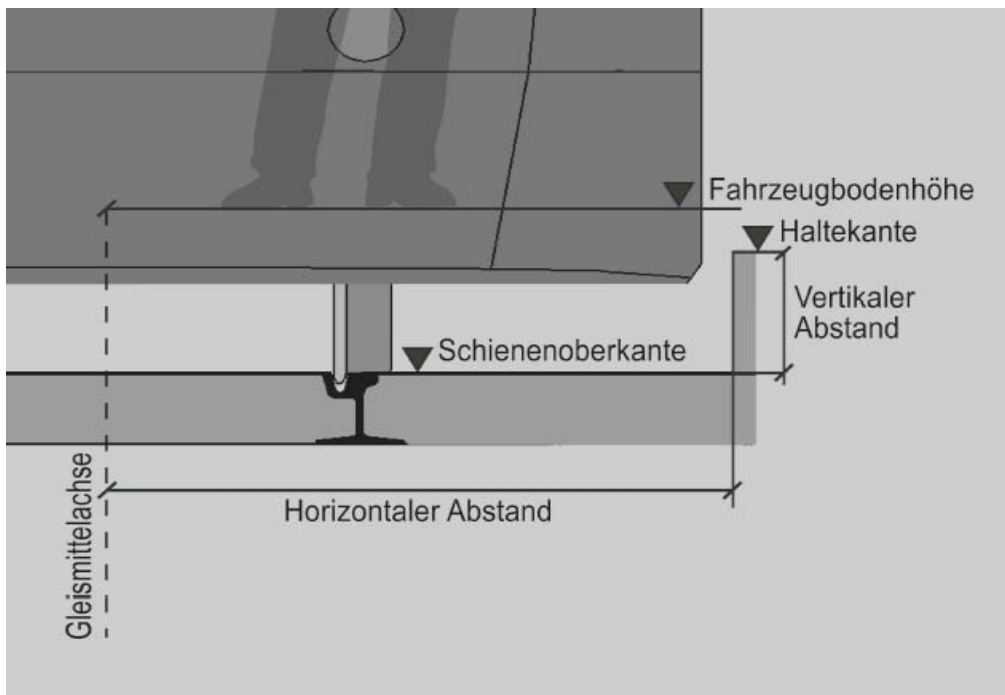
Zu betrachtende Abstände horizontal und vertikal
